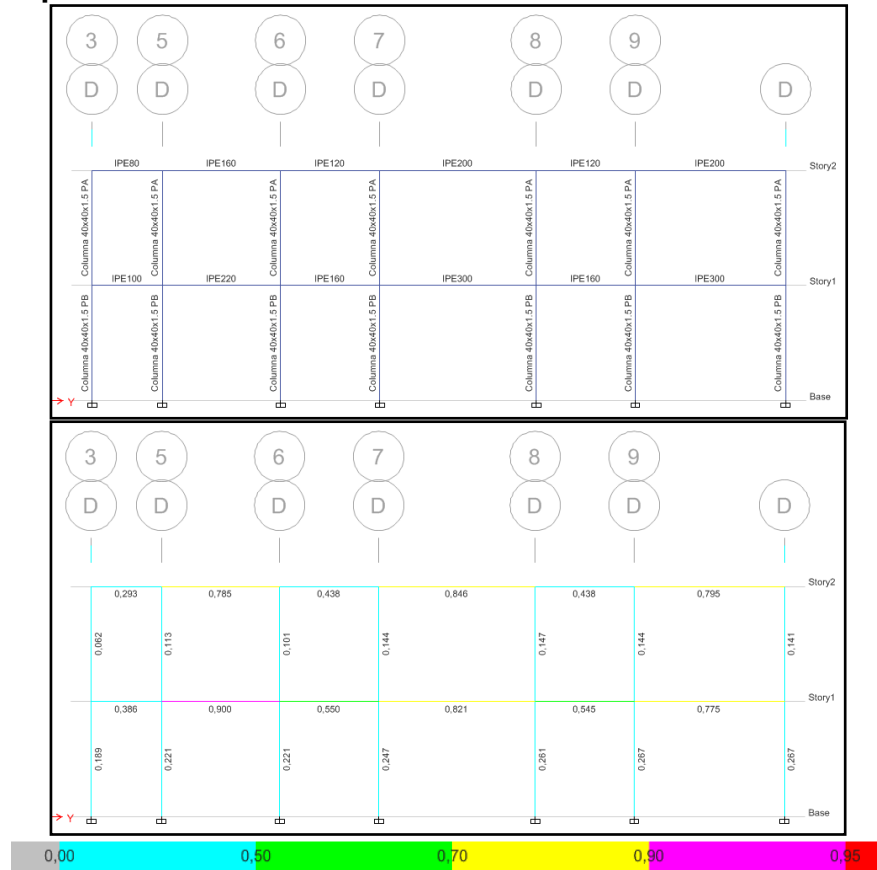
Demanda/Capacidad viga secundaria de planta alta bloque 1
